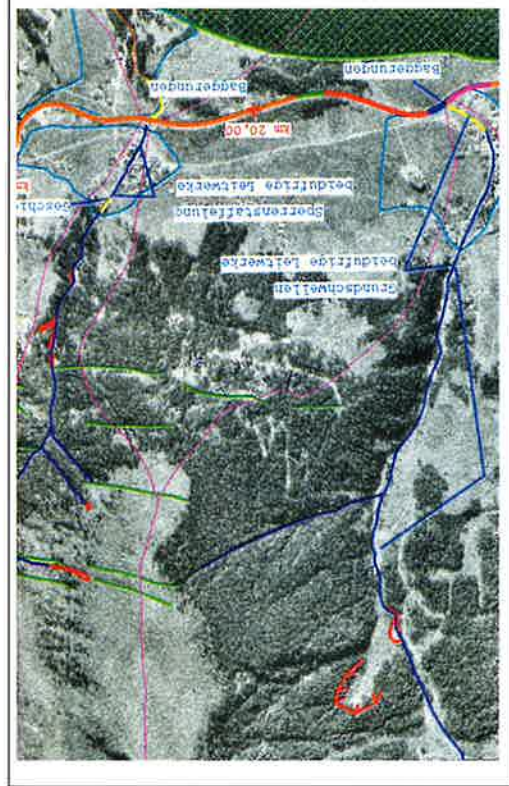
Plan „Zubringer und laufende Sohl-
